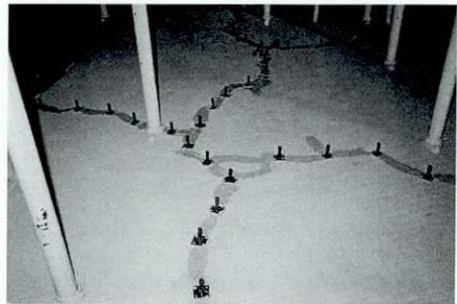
エポキシ樹脂による補強 (床スラブ)
